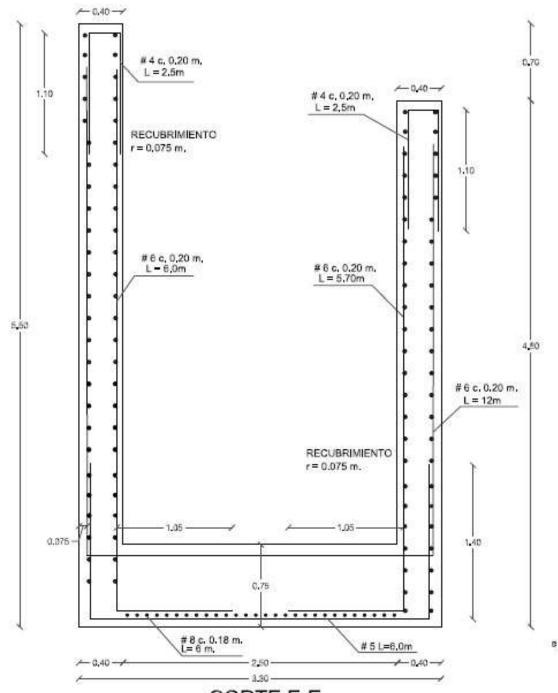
DESPIECE ACERO HORIZONTAL
